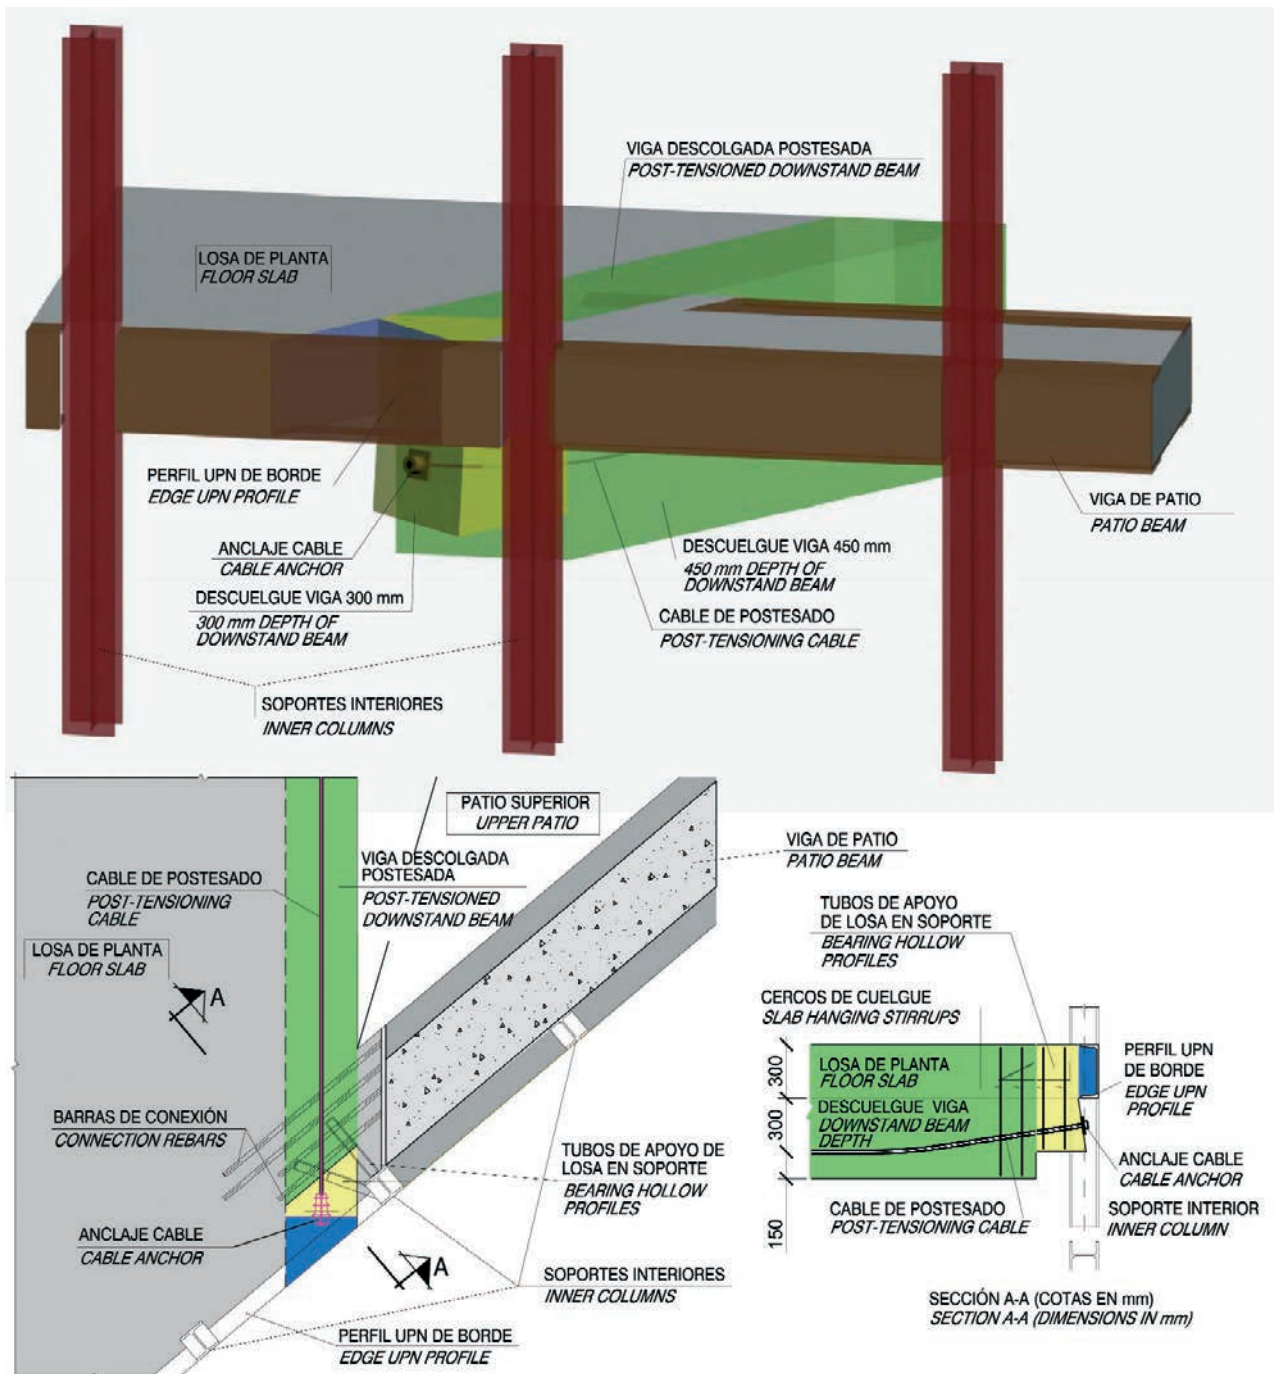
Detalle de apoyo de viga descolgada postesada en soporte metálico y encuentro con viga de patio
